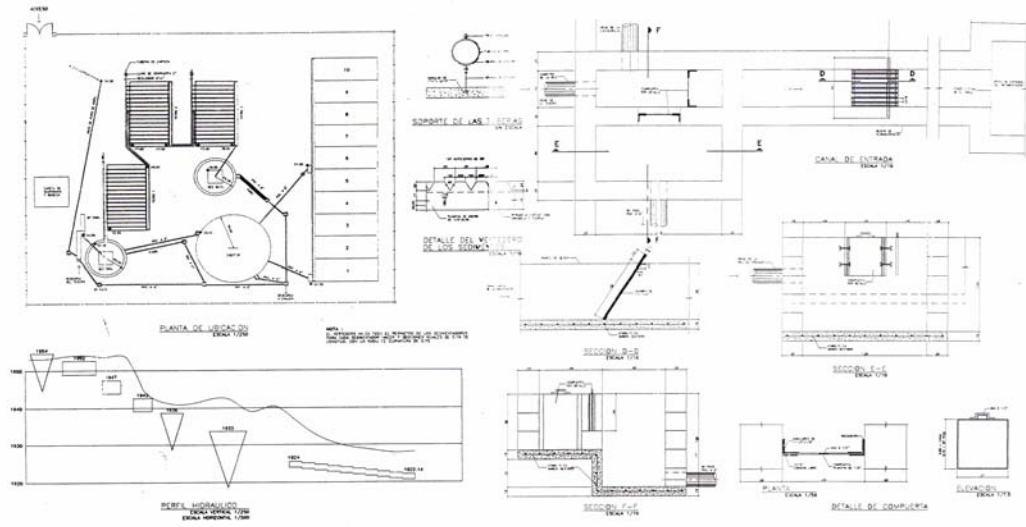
Plano de sedimentadores primario y secundario de la planta de tratamiento tradicional
